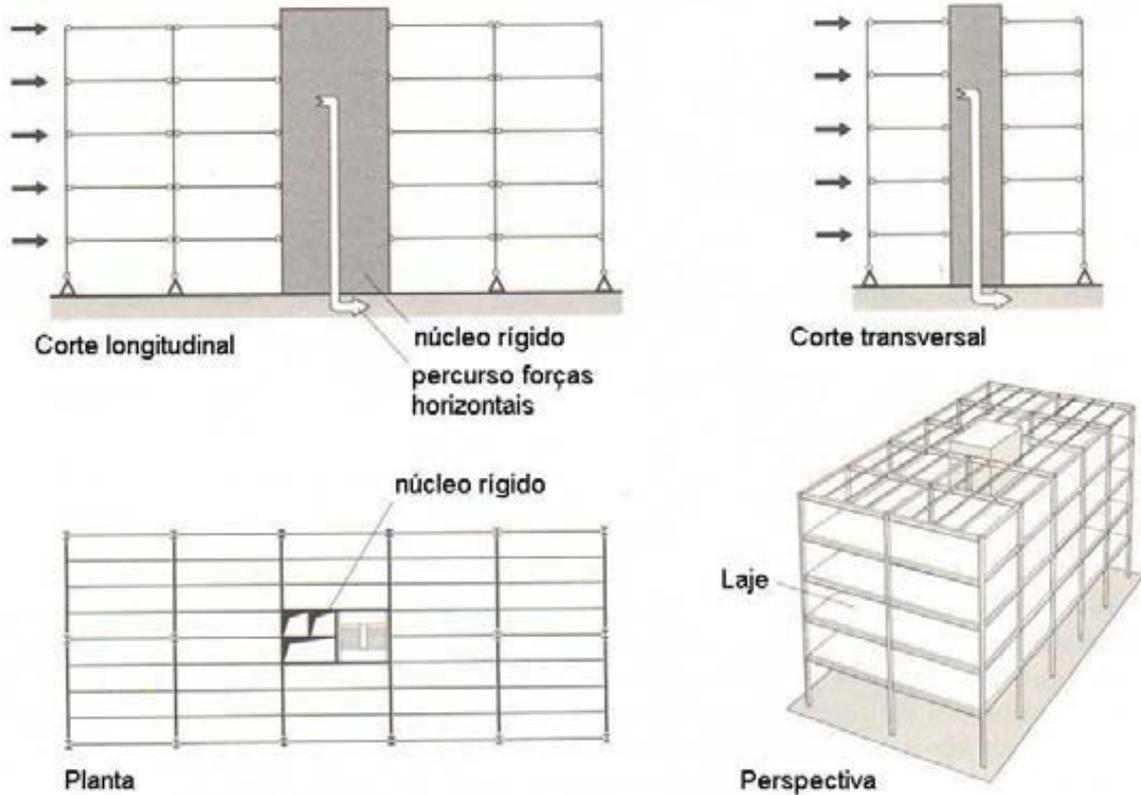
Esquema de pórtico metálico contraventado com núcleo rígido
